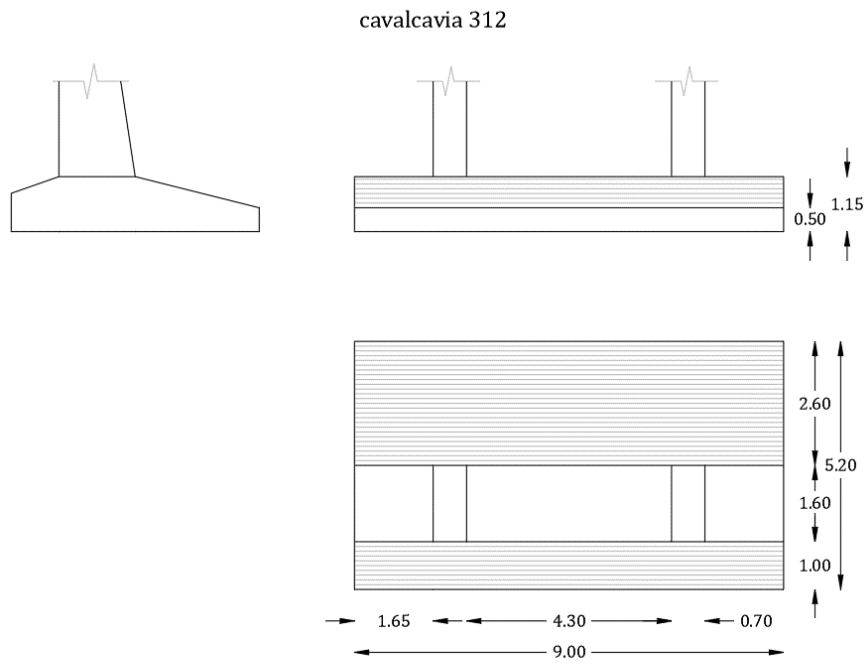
Sezioni delle fondazioni delle spalle
